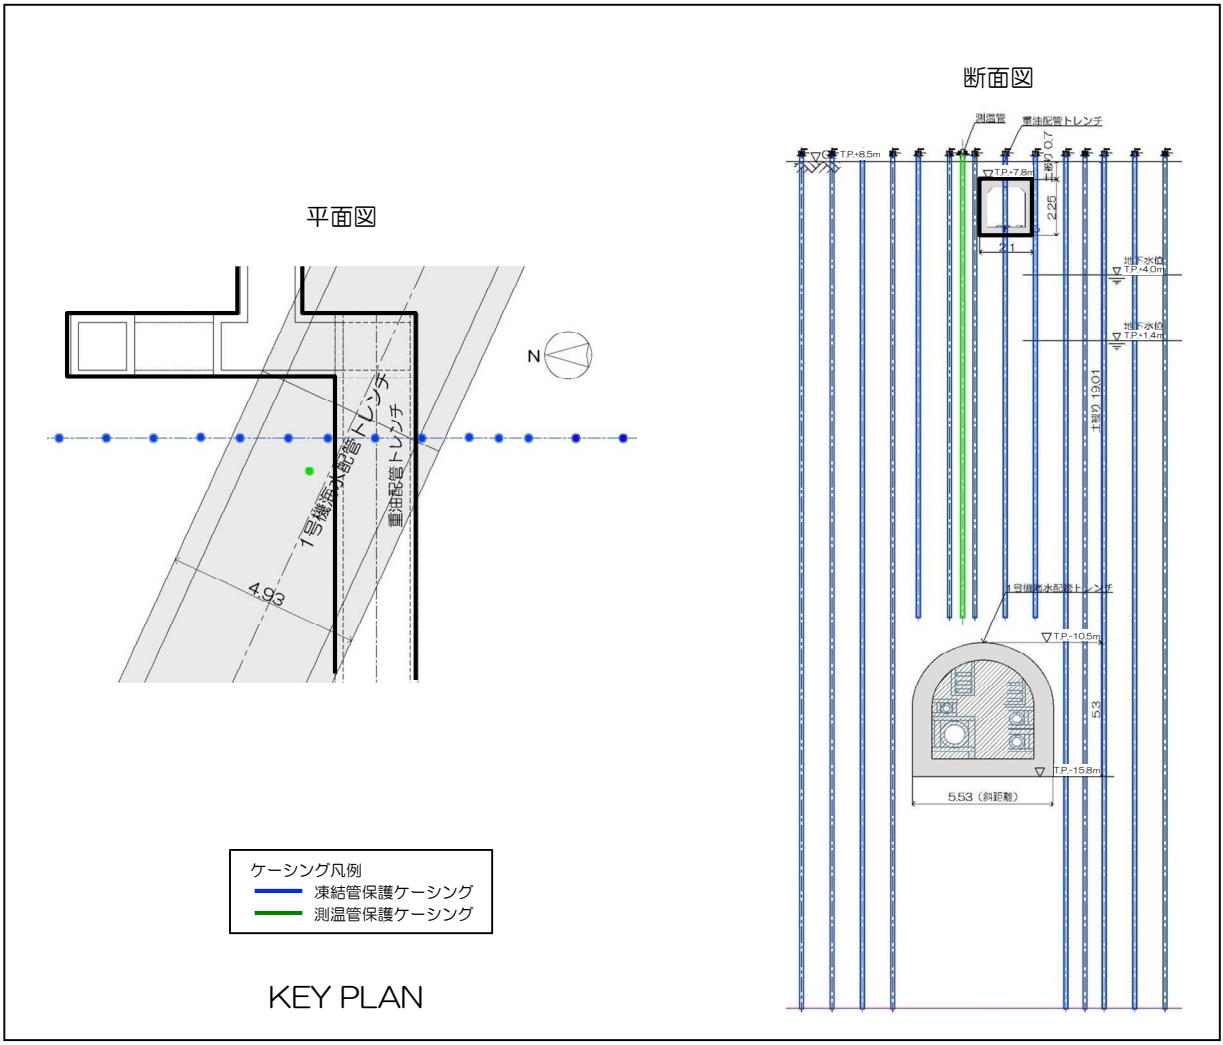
【13-1】重油配管トレンチ 施工方法（貫通施工）
